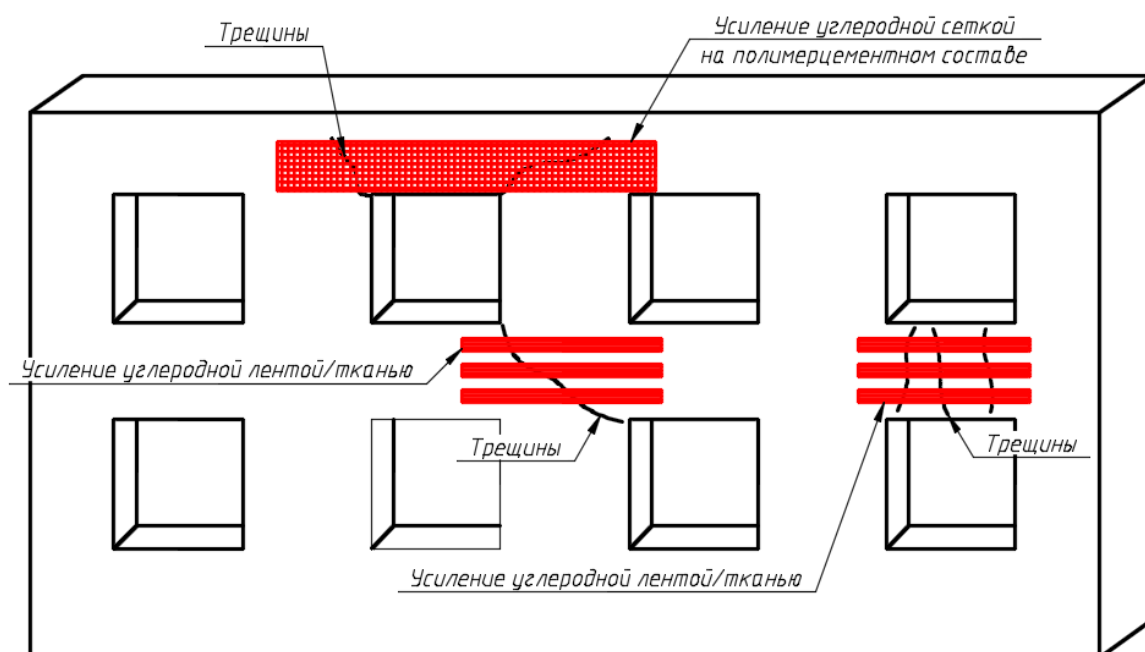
Усиление стены при действии горизонтальной нагрузки
